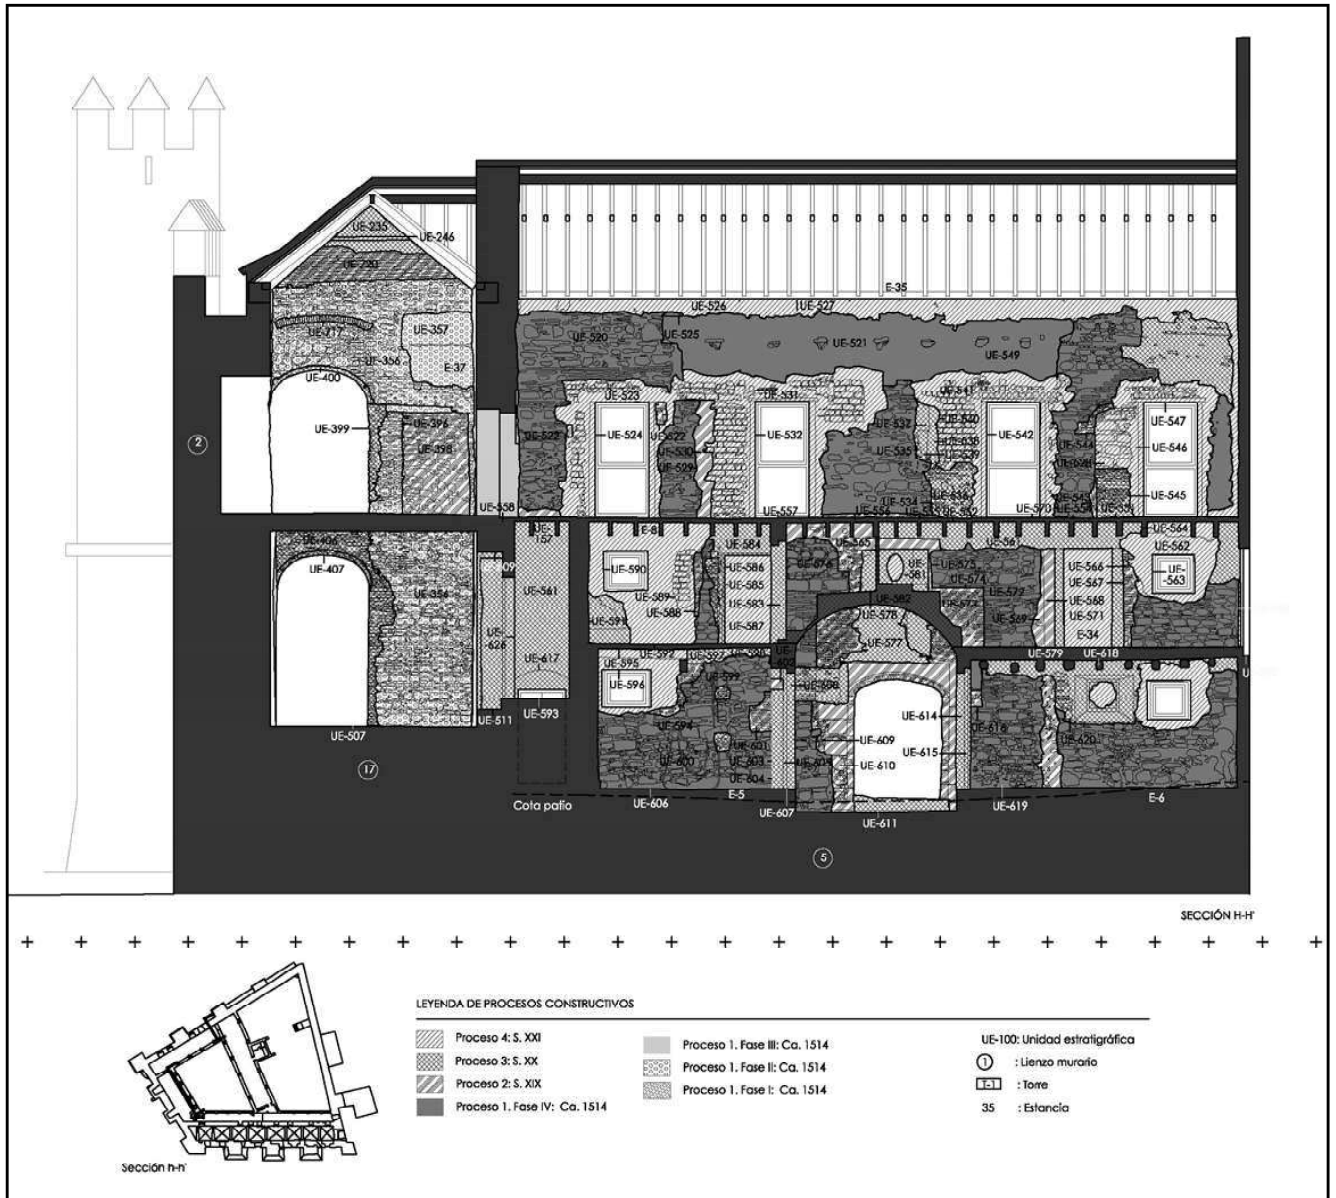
Estudio de alzados del muro oriental del pabellón norte con detalle de la puerta monumental anulada por la construcción de la entreplanta.
